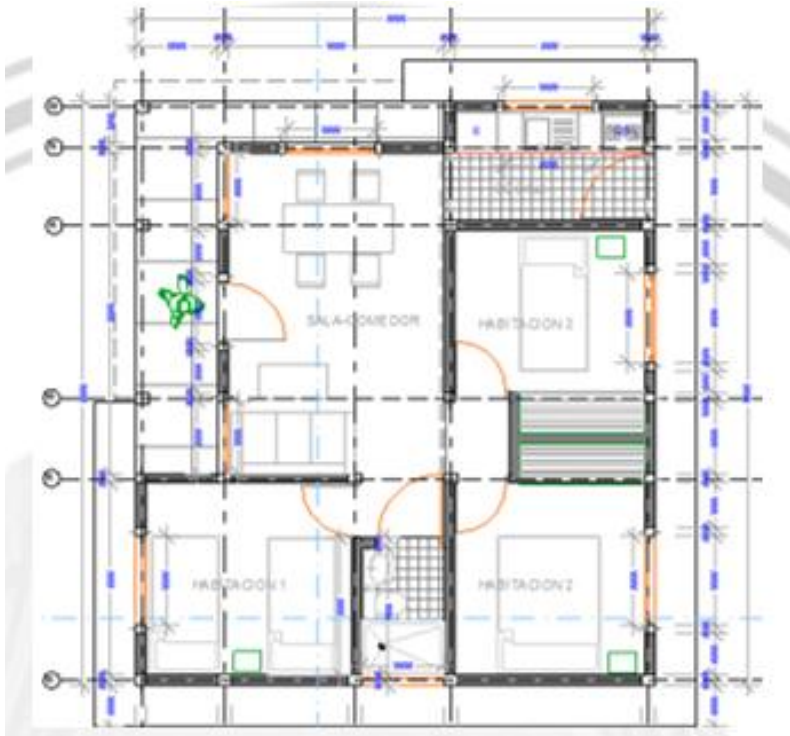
Planta Arquitectónica Proyecto Gobernación Vivienda Nueva [19]
